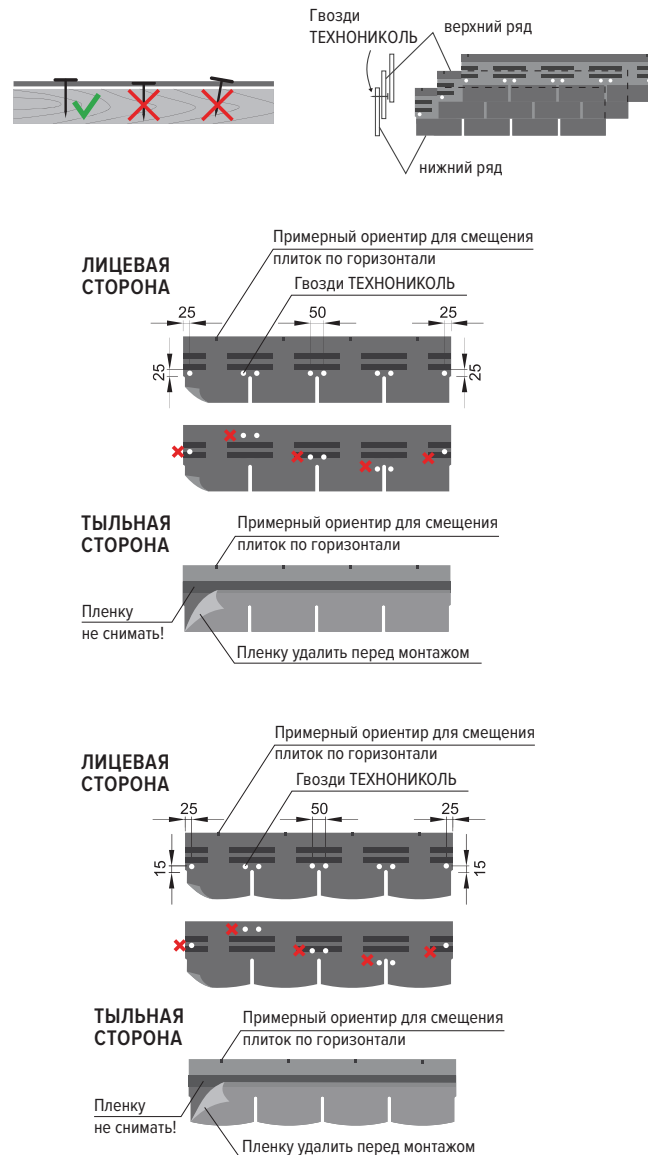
Схема крепления фасадной плитки на 8 гвоздей
